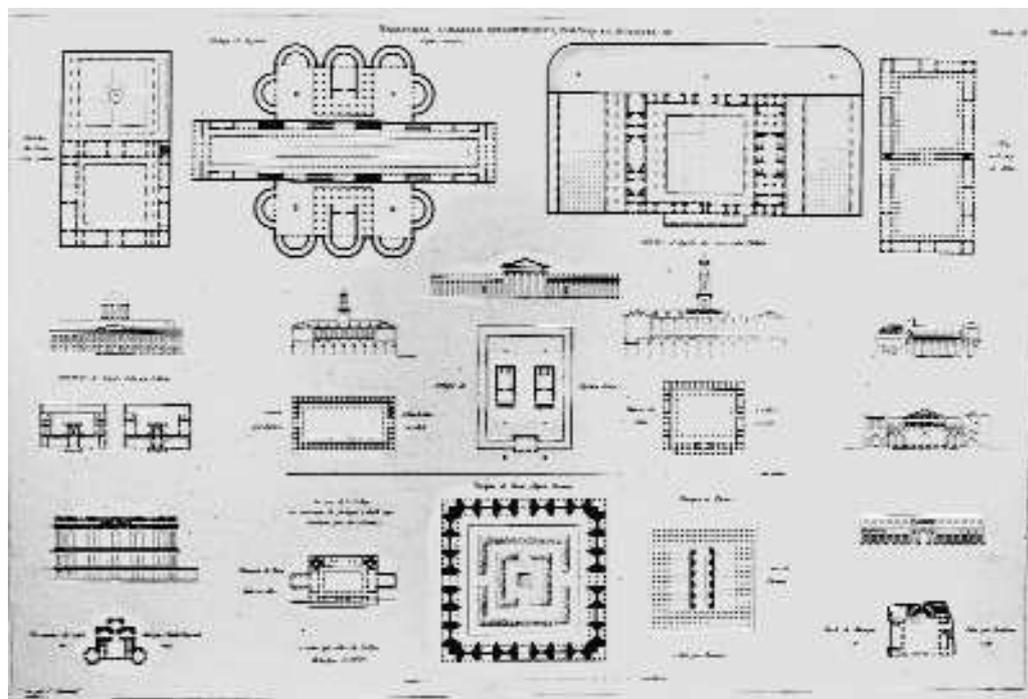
Durand, Ältere und neuere öffentliche Gebäude, Auf- und Grundrisse, 1800/01
